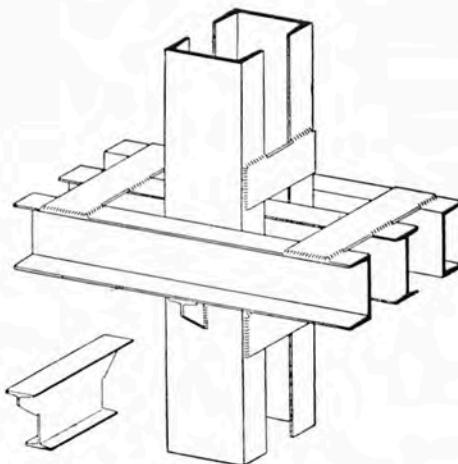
Assemblage d'une poutre longitudinale à une colonne.
